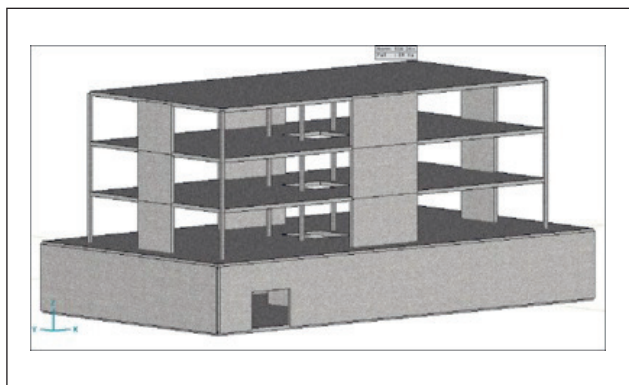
Primärstruktur mit ungeschwächten Betonscheiben.
